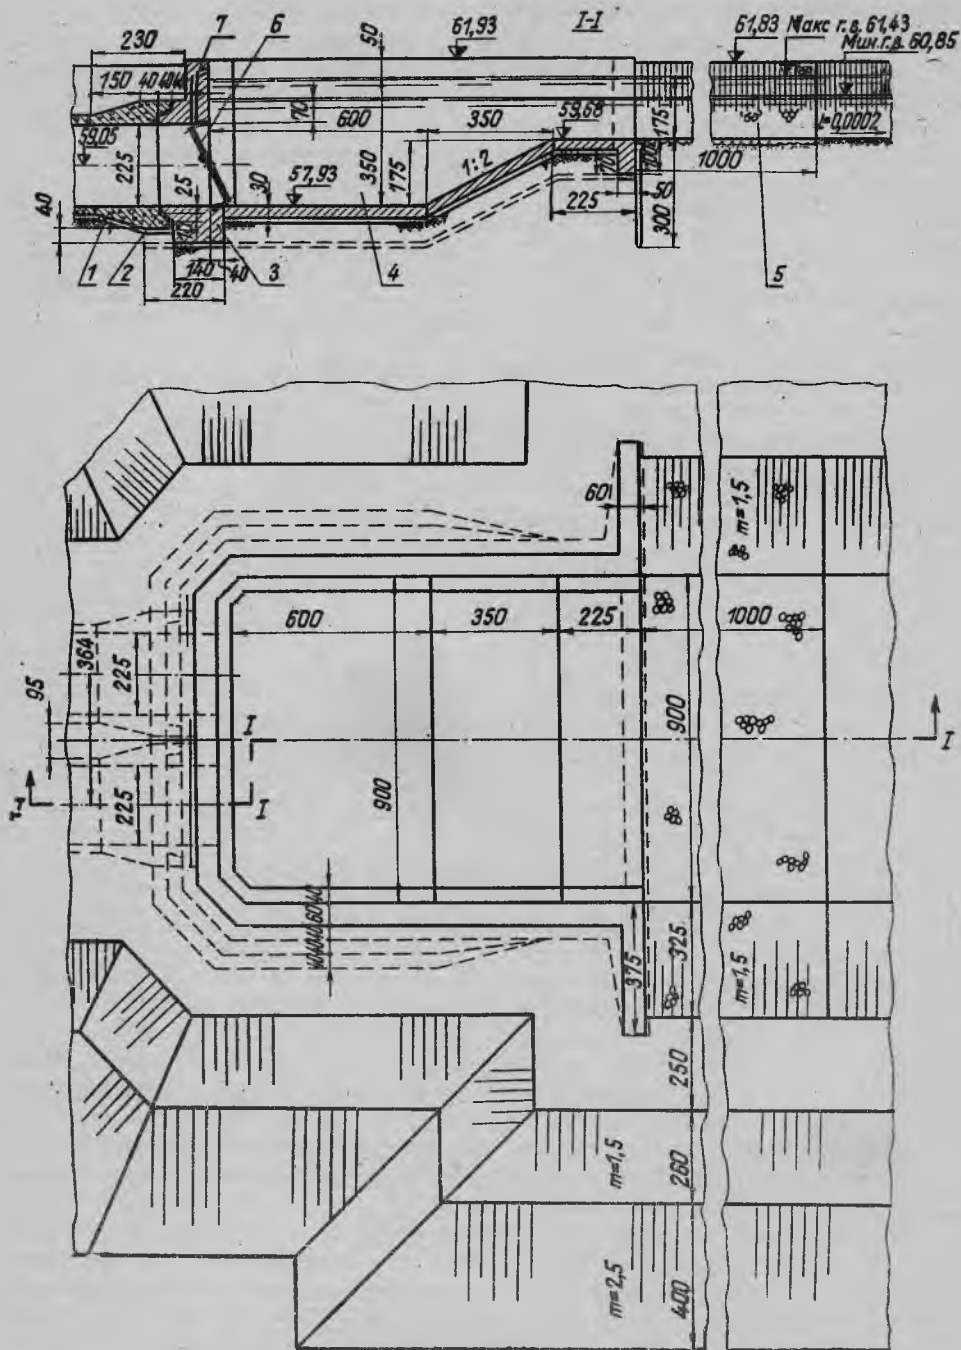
Напорный бассейн с общей камерой для нескольких напорных трубопроводов:
